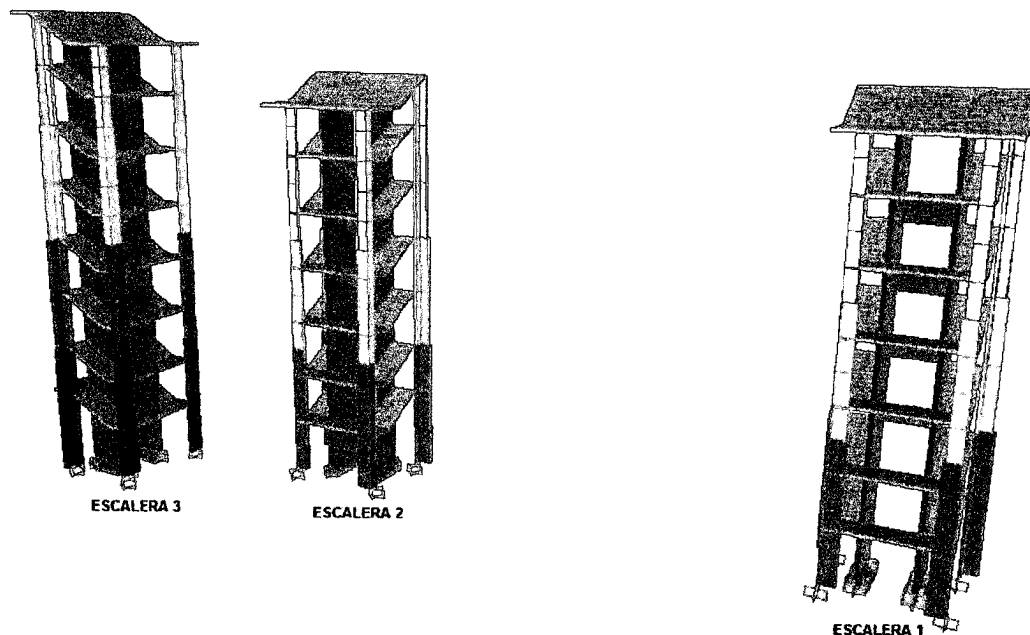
, Detalle modelado de 3 estructura de escaleras principales.
